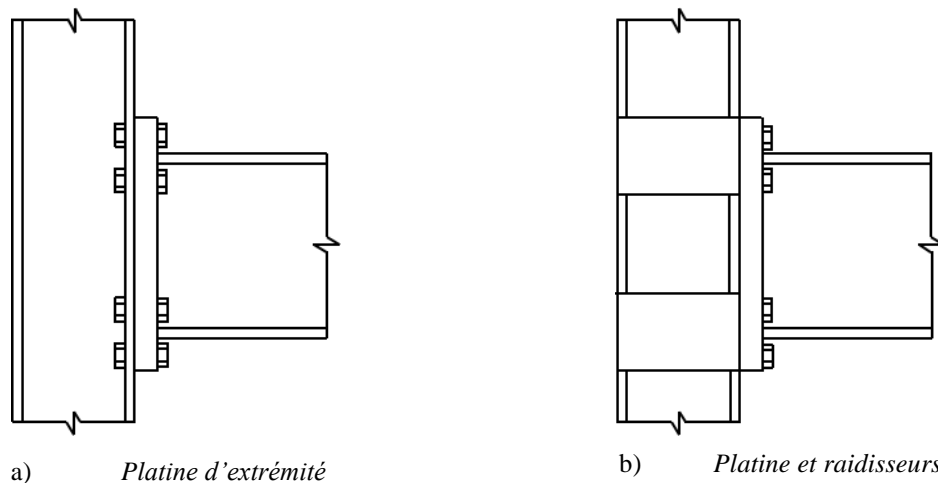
Assemblages poteau-poutre permettant un maintien vis-à-vis du gauchissement
